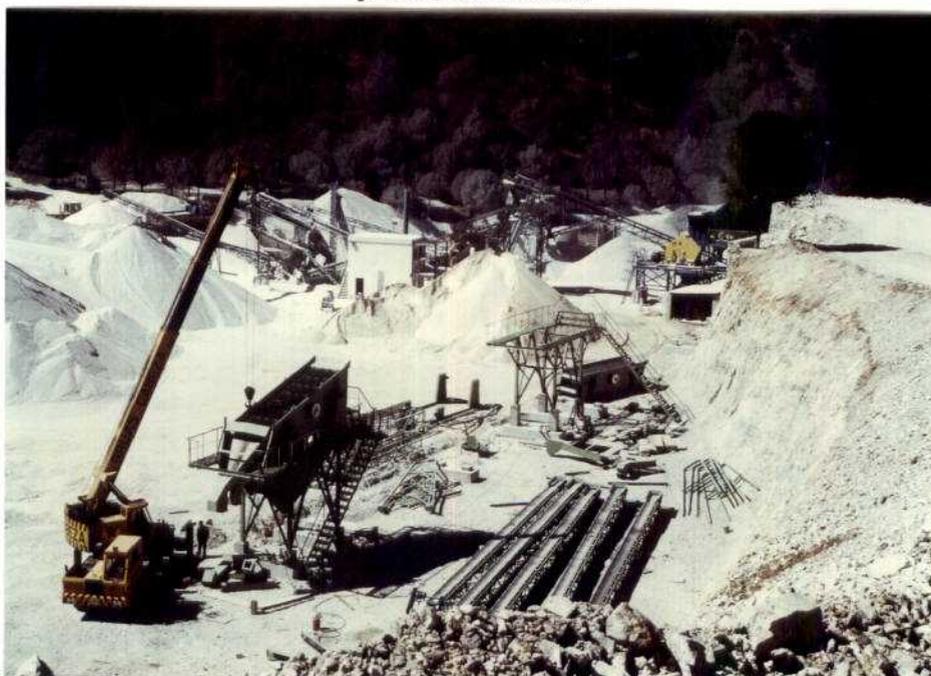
Infraestructura previa a la instalación de la ampliación de la planta de tratamiento.
